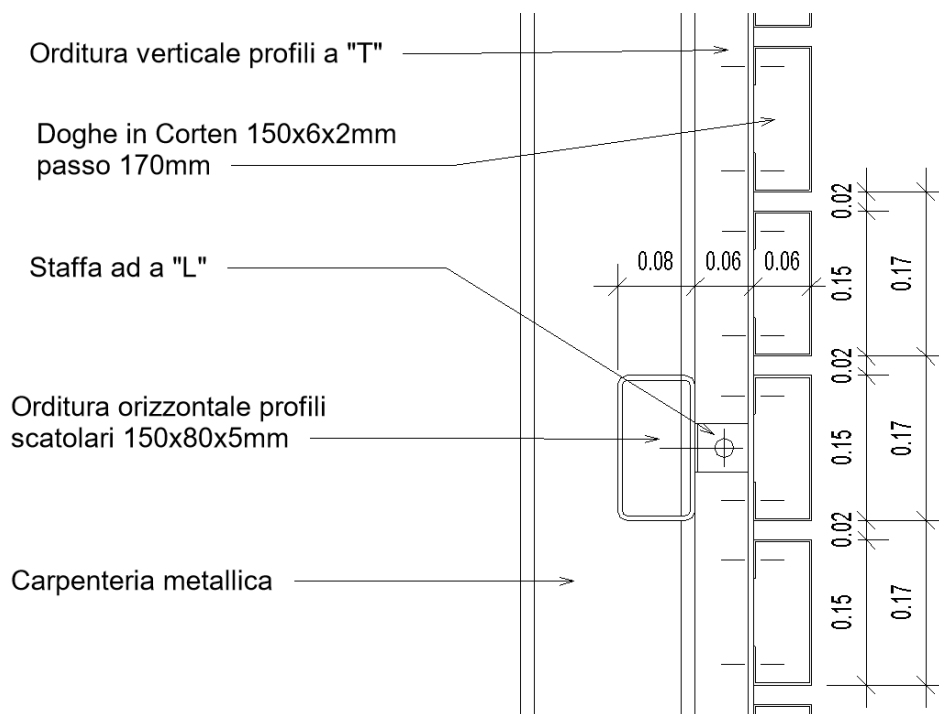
Dettaglio costruttivo dell'ancoraggio delle doghe alla struttura metallica – sez. trasversale
